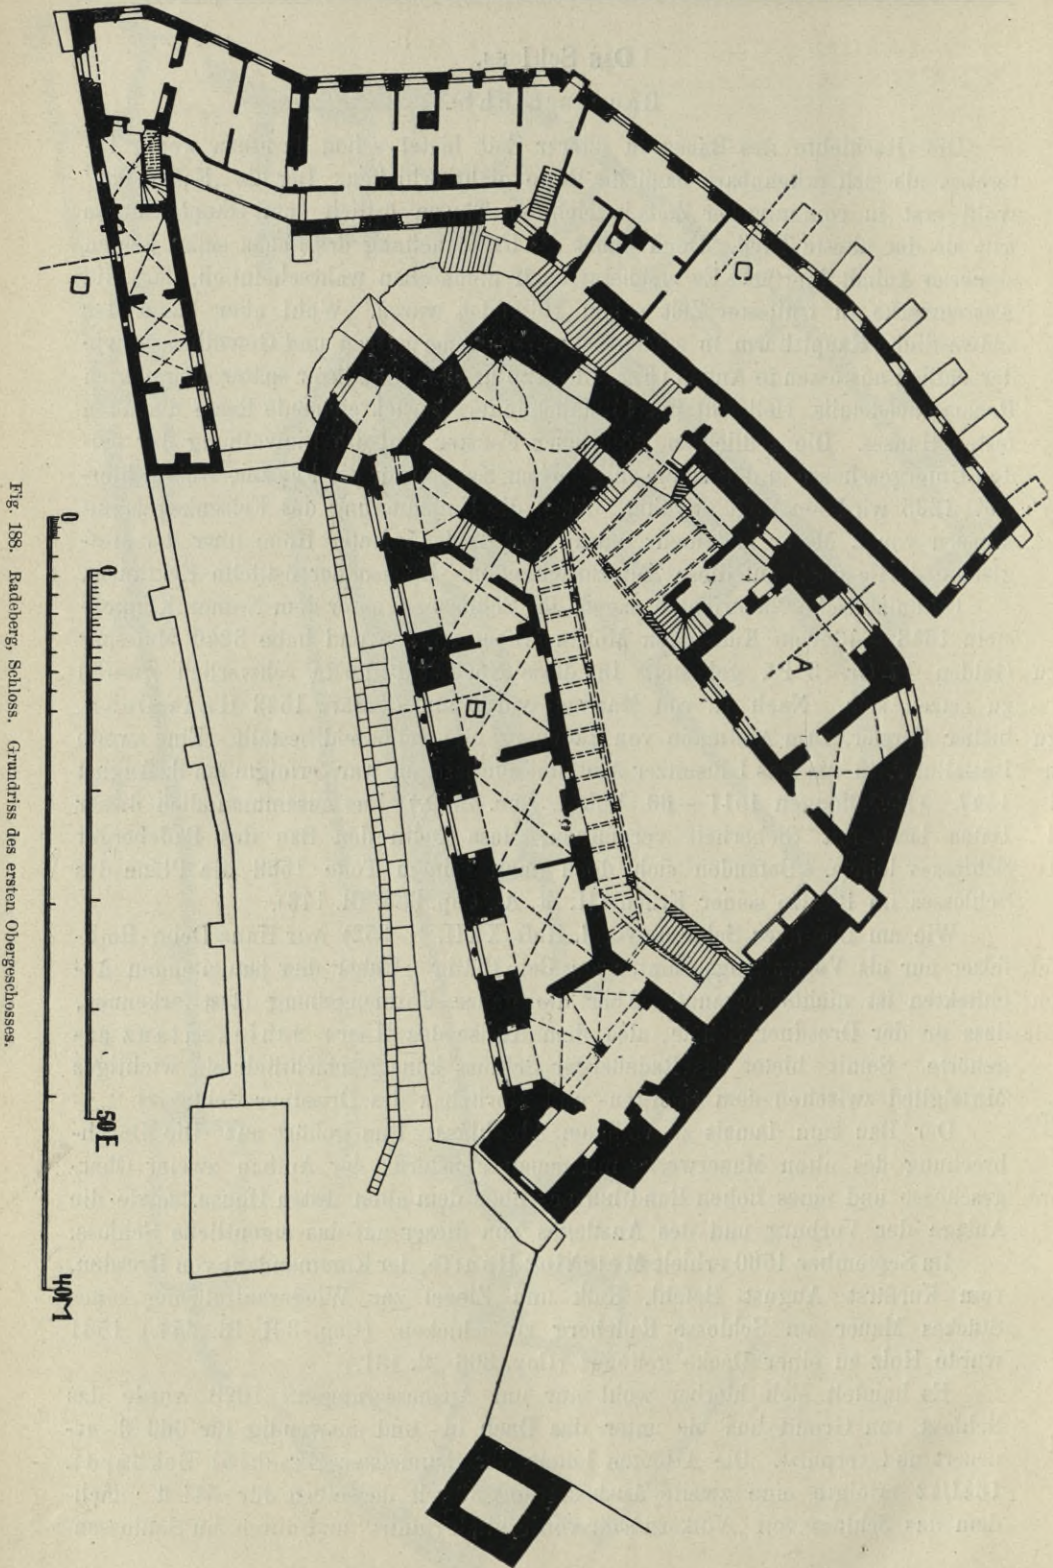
Radeberg, Schloss. Grundriss des ersten Obergeschosses.
